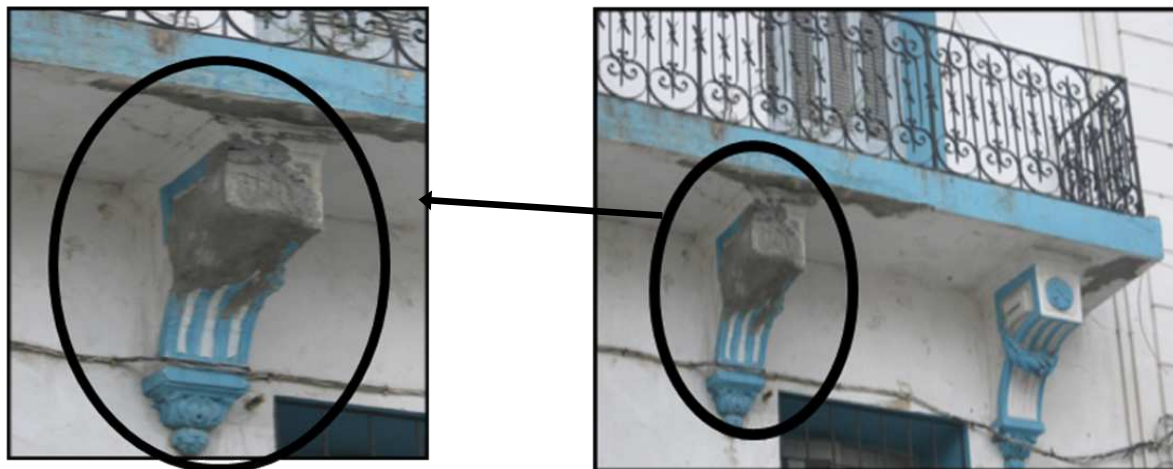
Ornement architectural de la façade de centre ville de Mostaganem remédié d'une façon aléatoire
